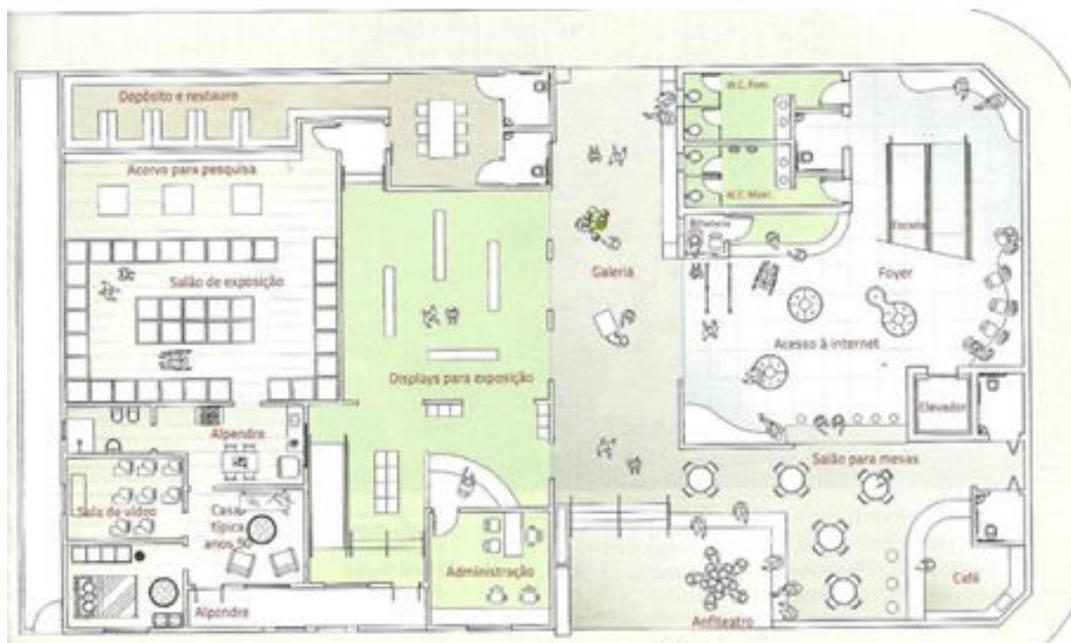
Planta do pavimento térreo da Casa da Cultura (ENFOQUE, 2011:53).
